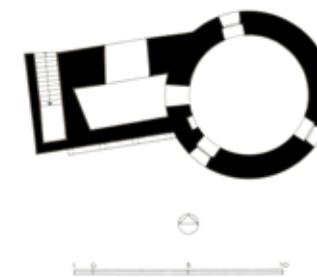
Grundriss des Untergeschosses, BDA Planarchiv Wien. M 1:400.
